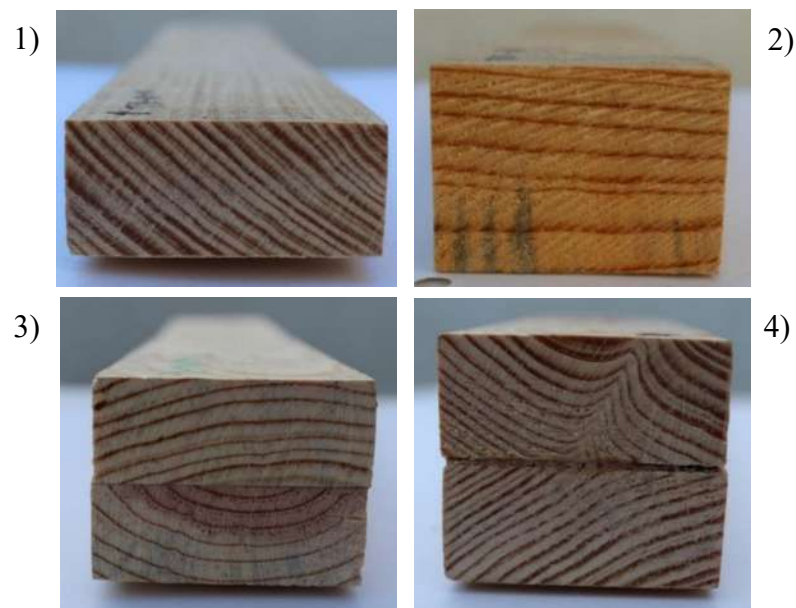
Variantes de las piezas estructurales 1) T-a pieza de madera maciza (testigo),
